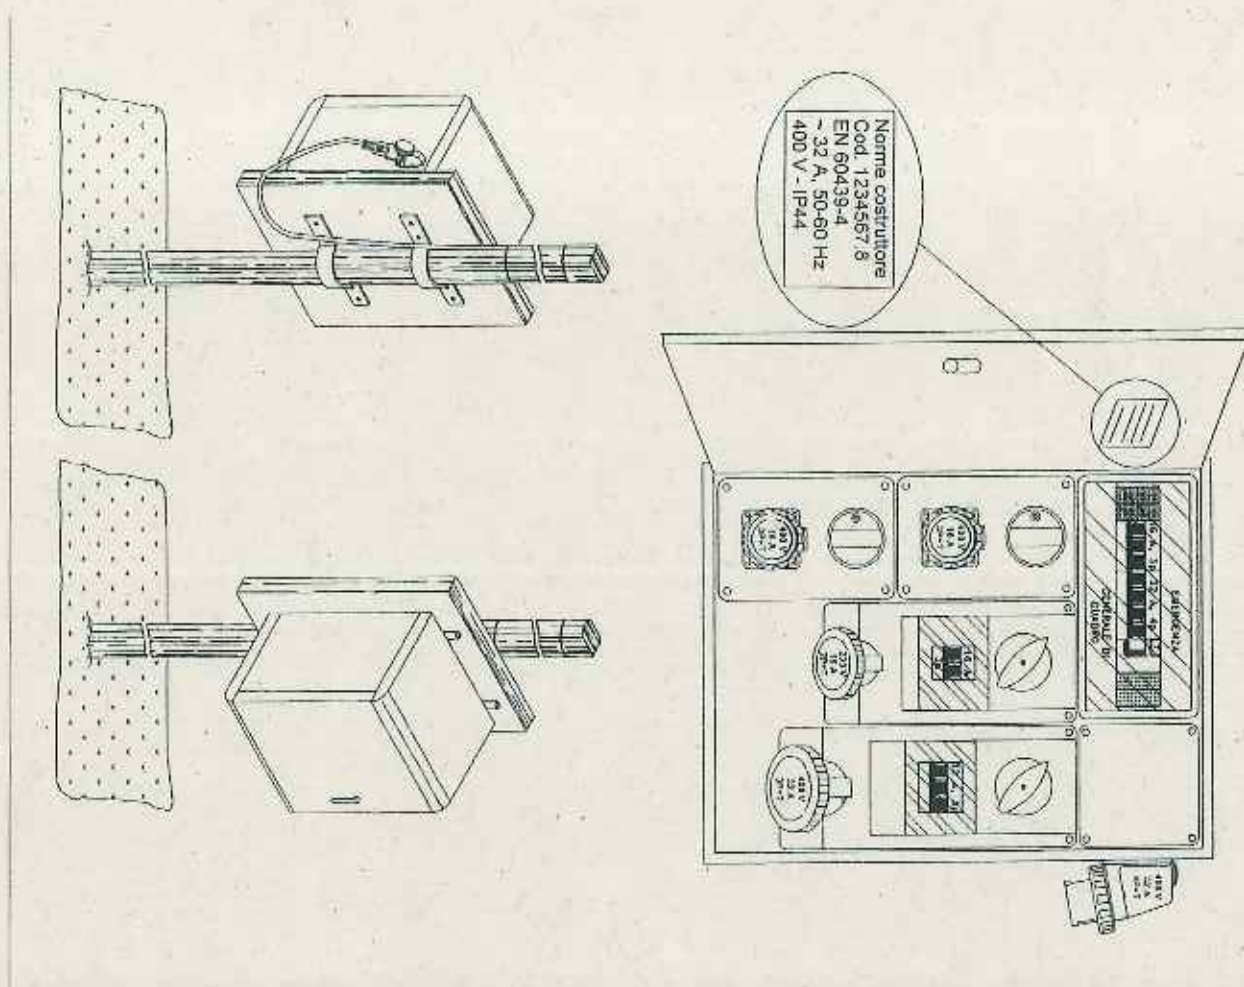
Cantiere medio (25 kW) - Prospetto e sistema di installazione del quadro Q2.
